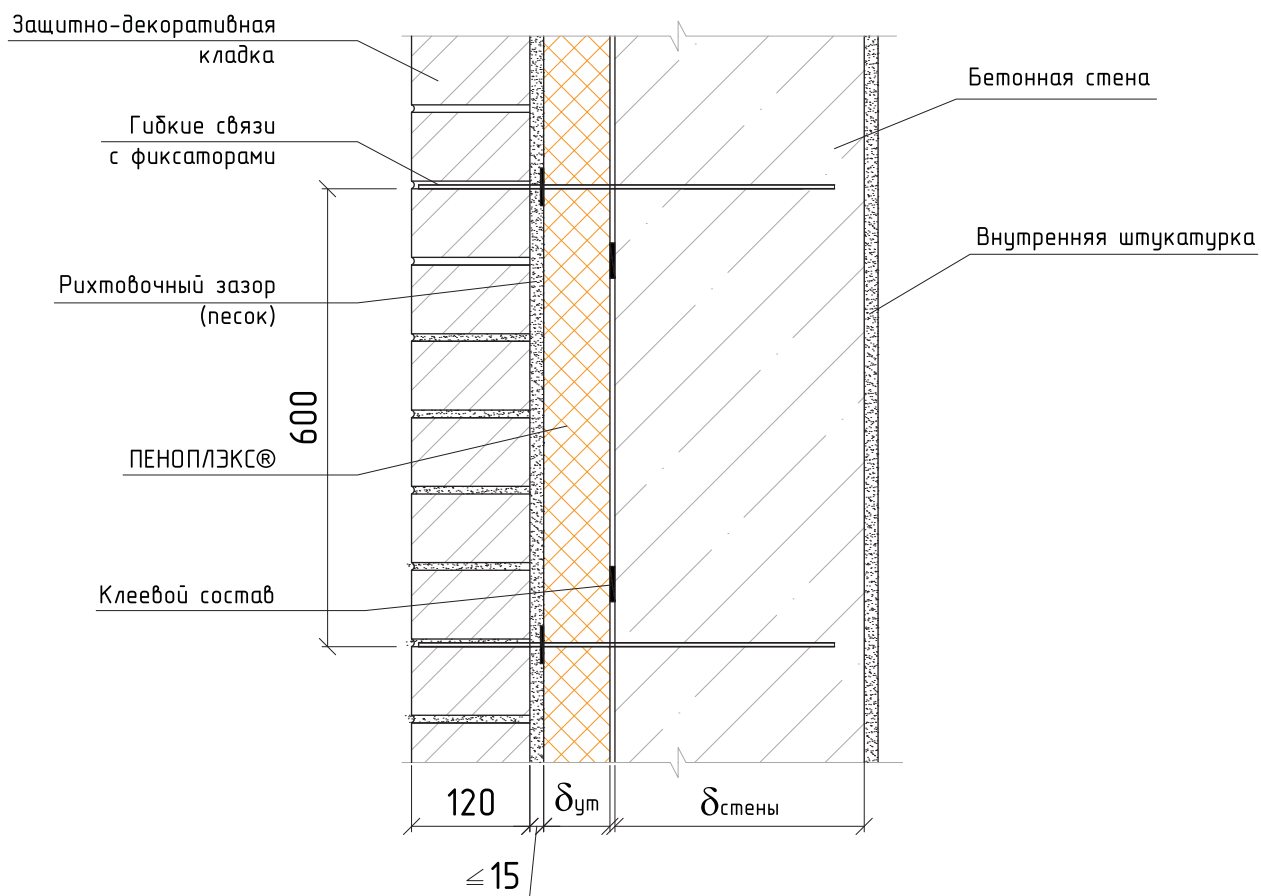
Схема конструкции стены первого или цокольного этажа №4
